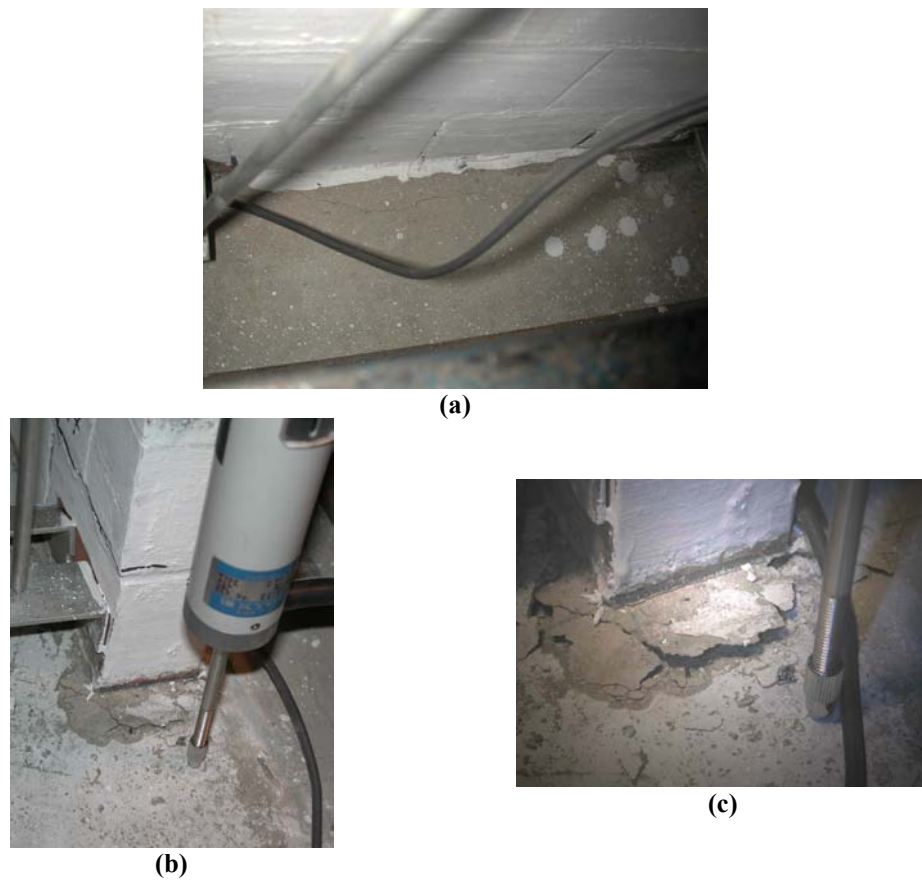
Fissuração na laje de base do painel PICG1: (a) Propagação ao longo da base do painel; (b) Fase inicial do desprendimento no canto tracionado; (c) Fase final do desprendimento no canto tracionado.
